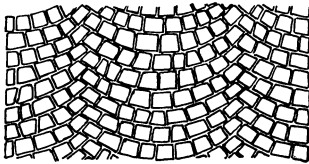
Kleinpflaster, segmentförmig verlegt.
